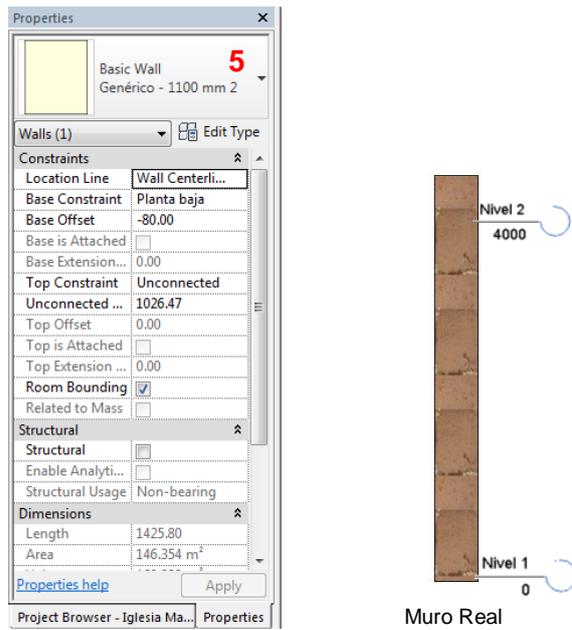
(A, B): Creación De los elementos constructivos de la Iglesia Santa María la Real de Mave en el software Autodesk Revit
